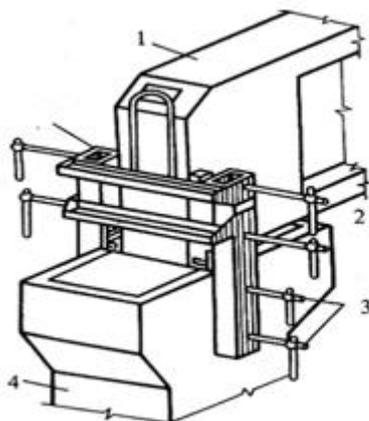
Применение фиксирующей распорки для временного крепления стропильной фермы
